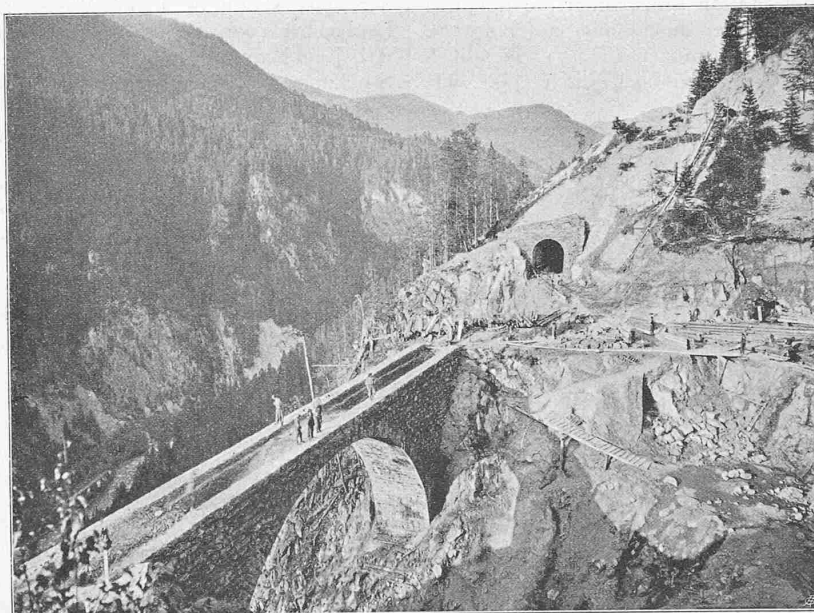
Pflanzgartenbrücke II, nach Vollendung des Mauerwerks.
